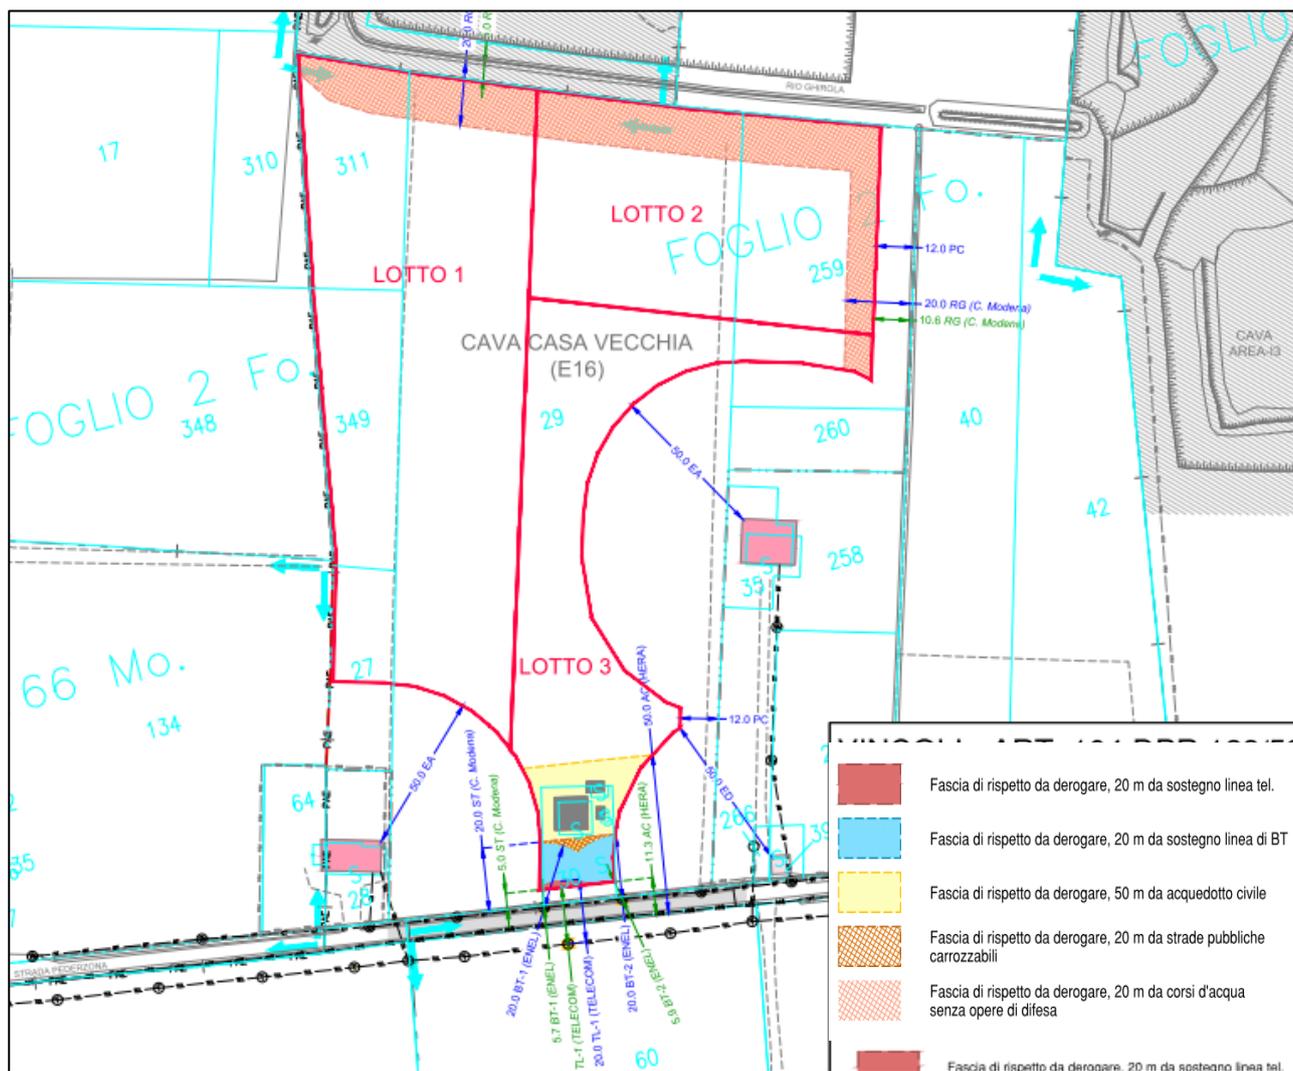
Estratto della Tavola T4i "Progetto – Planimetria dei vincoli"; fasce di rispetto dei vincoli.
